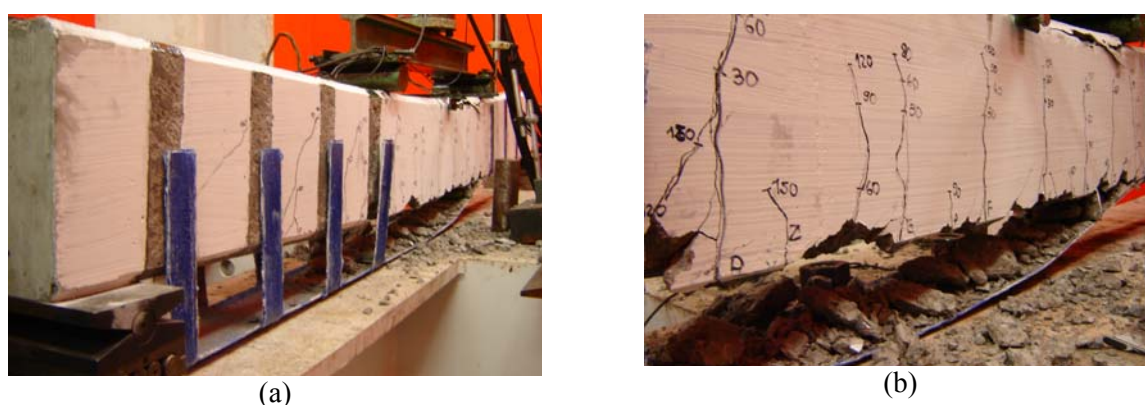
Viga VFV_02: (a) Viga após a ruptura do compósito; (b) Detalhe da ruptura no vão central da viga.
